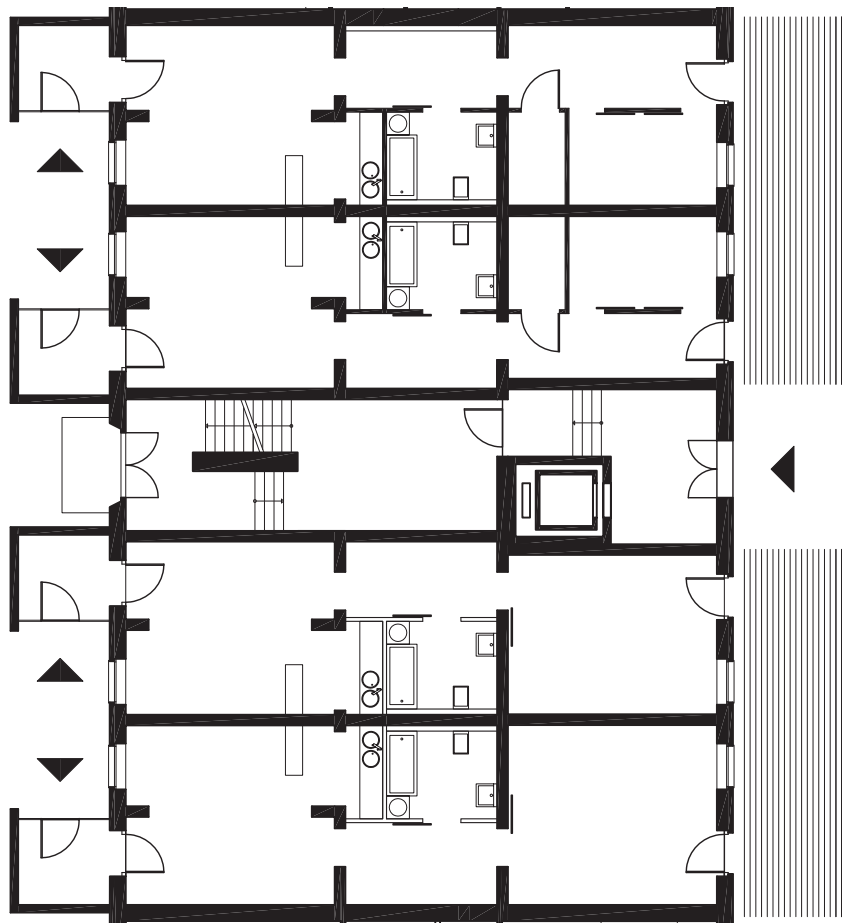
Haus Vier - Planung Erdgeschoss
